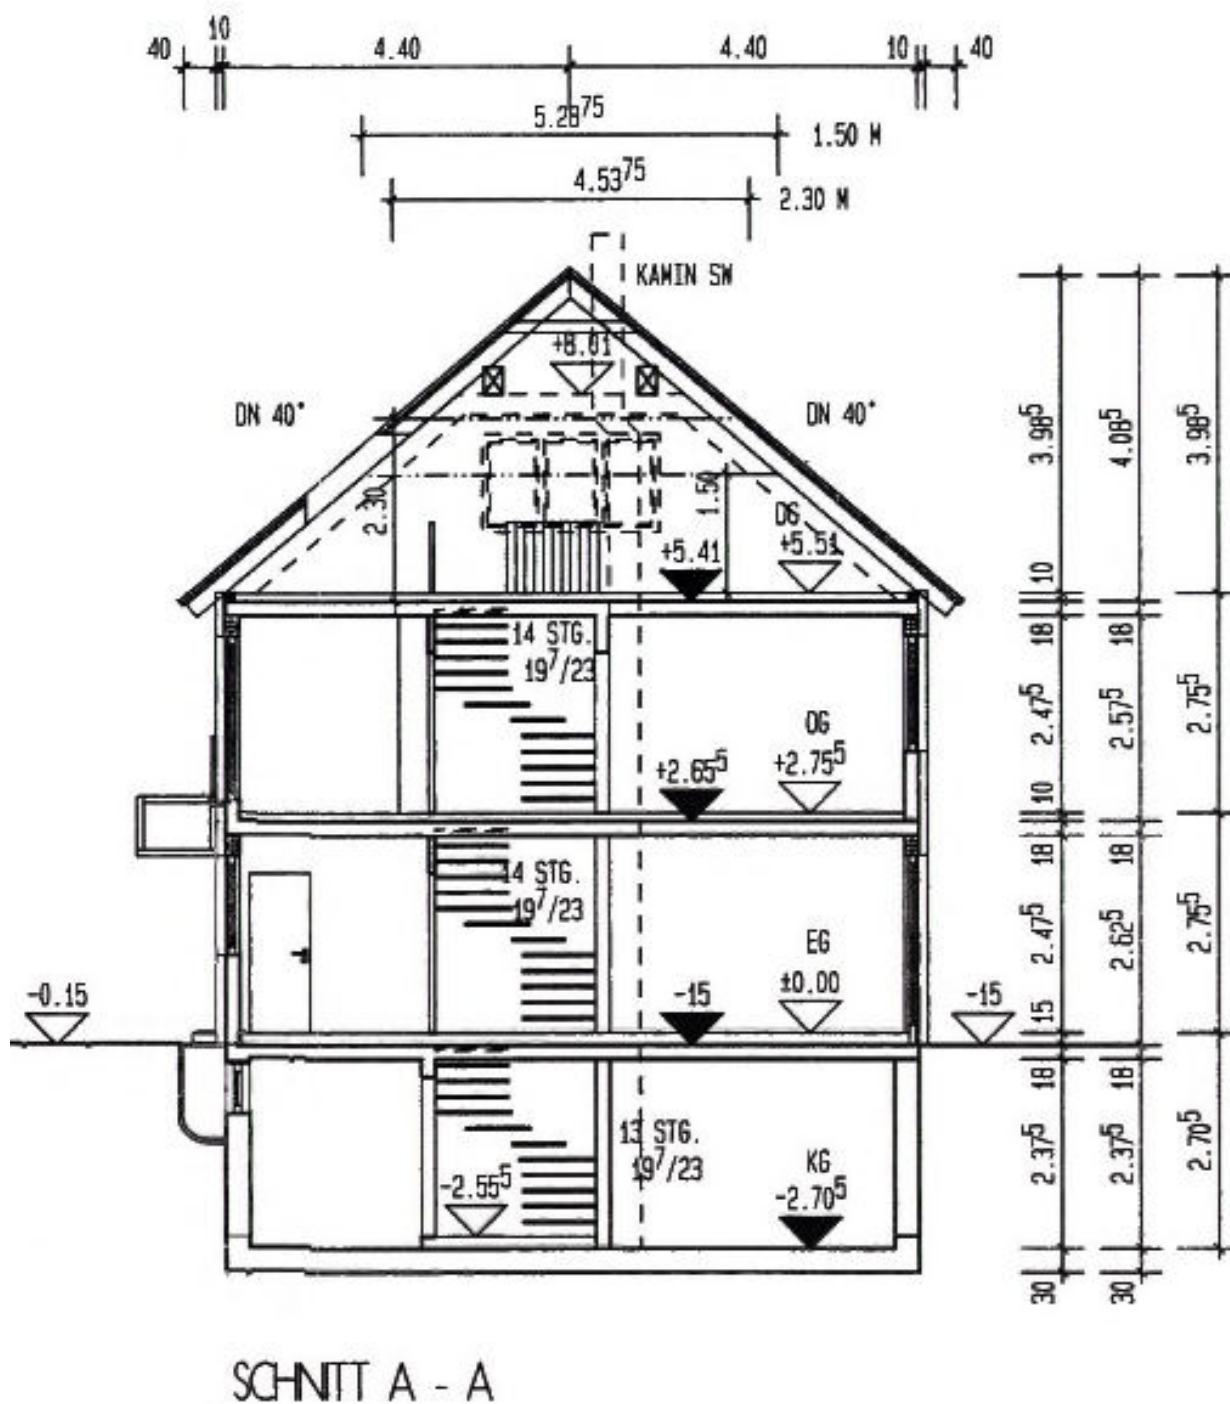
Gebäudeschnitt Haus 2 (ohne Maßstab); Quelle: Bauakte
